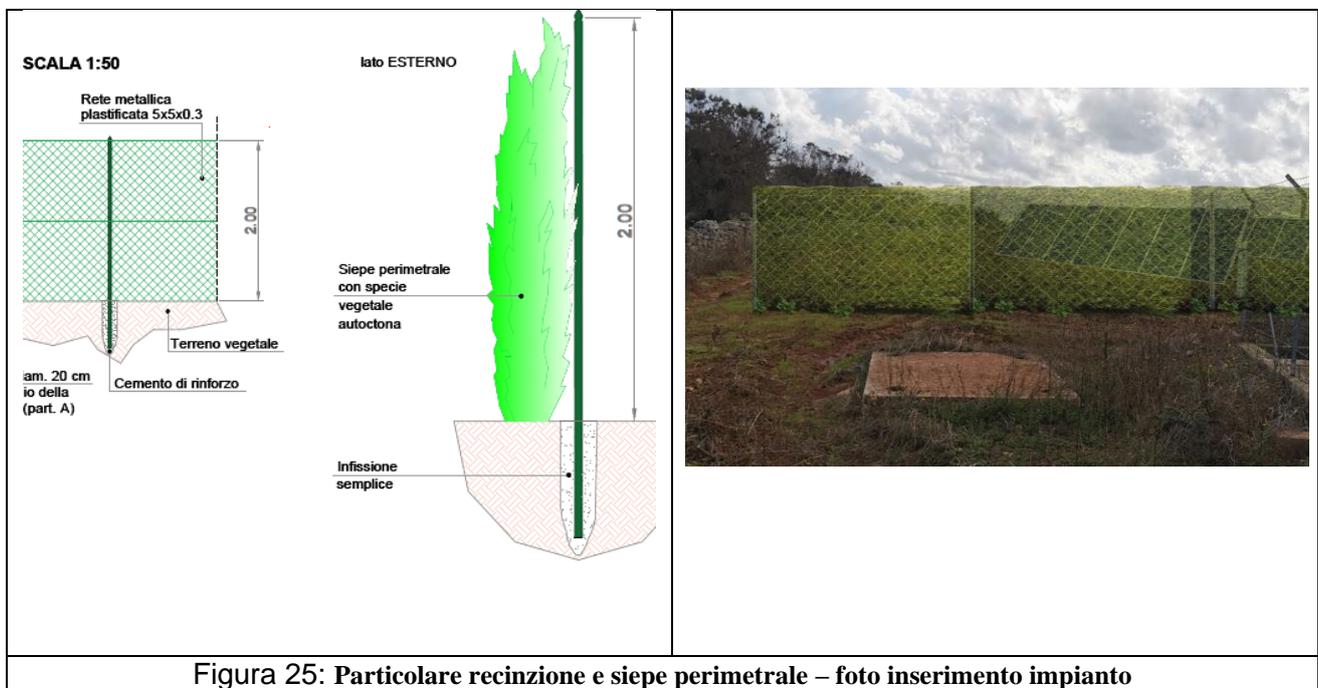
Particolare recinzione e siepe perimetrale – foto inserimento impianto
